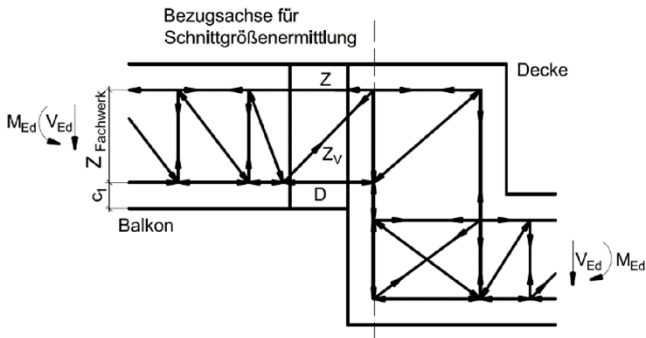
Schöck Isokorb® Typ K-O und K-O-F mit Anschluss an Höhenversatz
